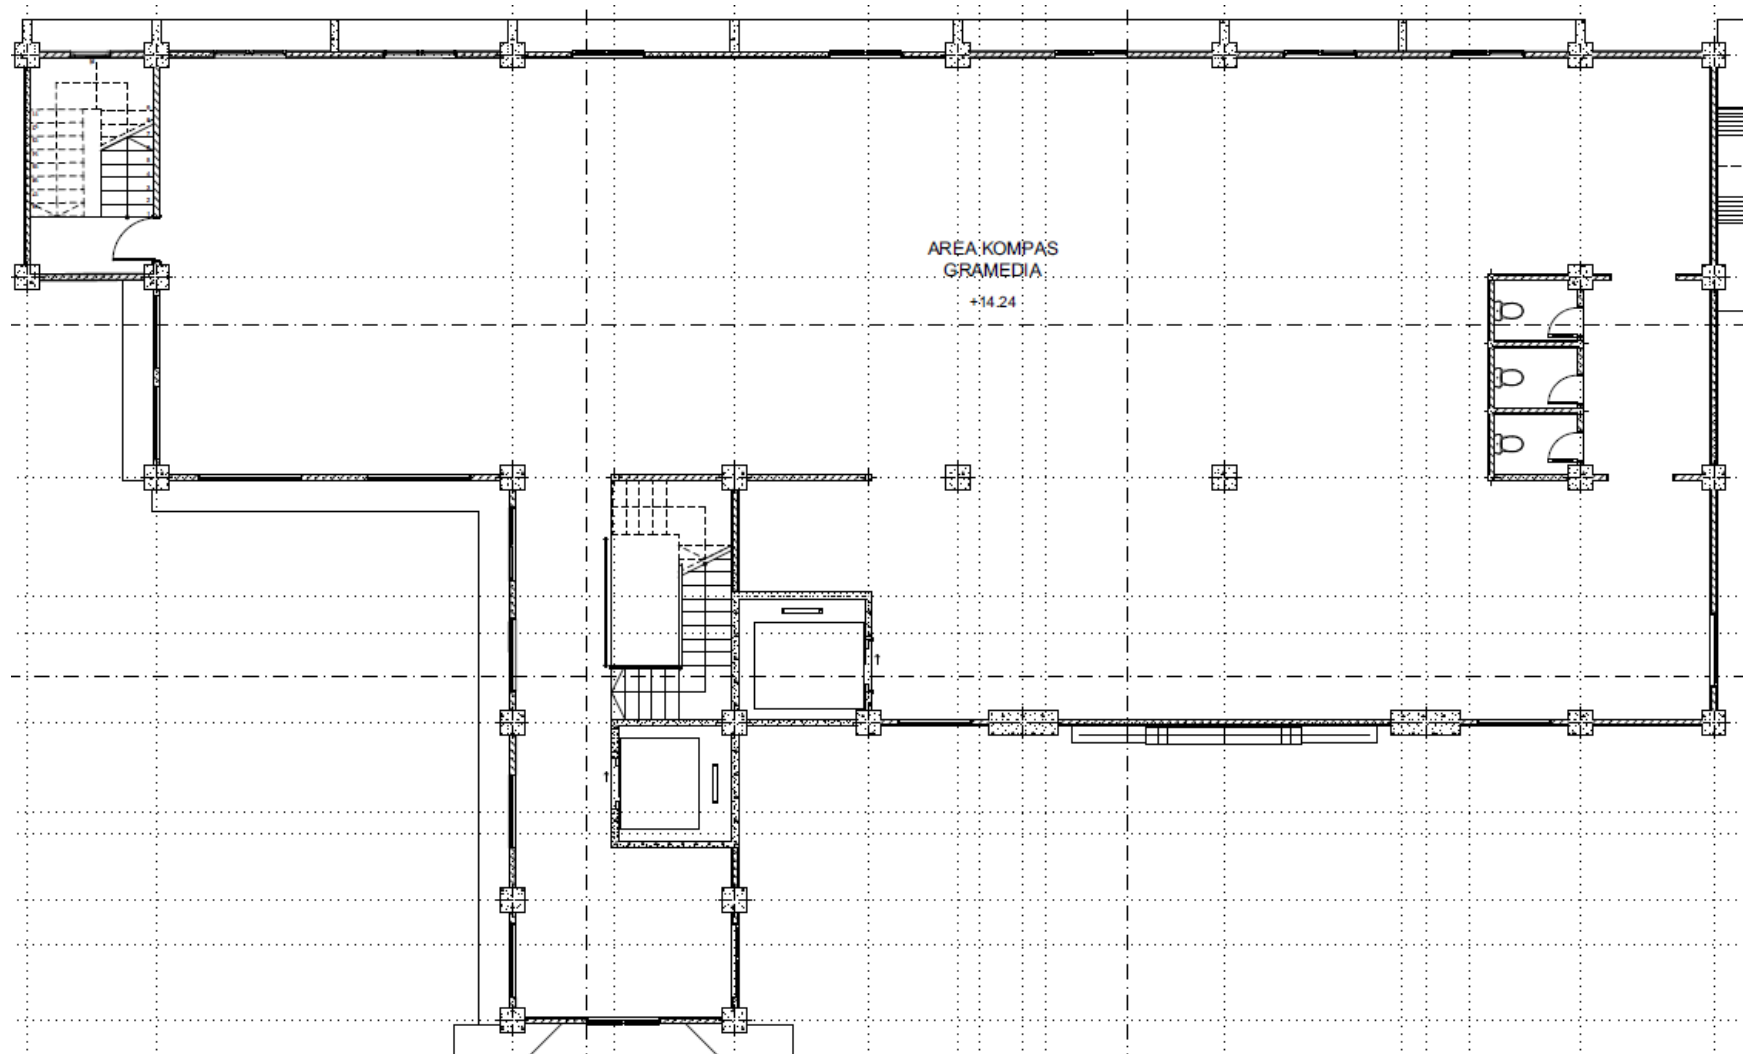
Denah Lantai 3 Ruang Pamer
